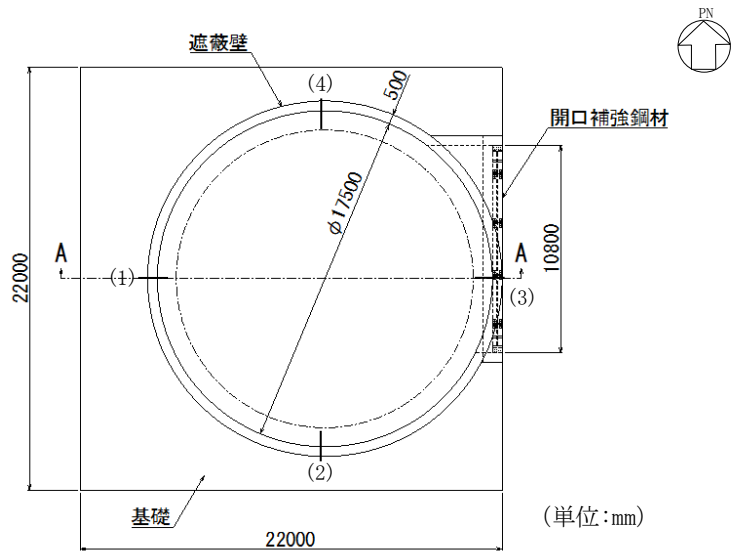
復水貯蔵タンク遮蔽壁 平面図
